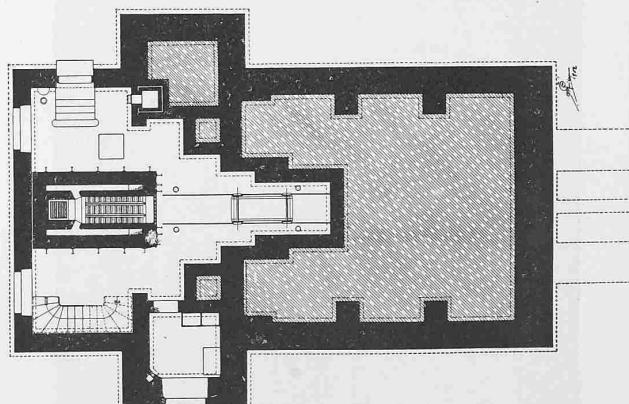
Grundriss vom Untergeschoss. — Maßstab 1:250.
